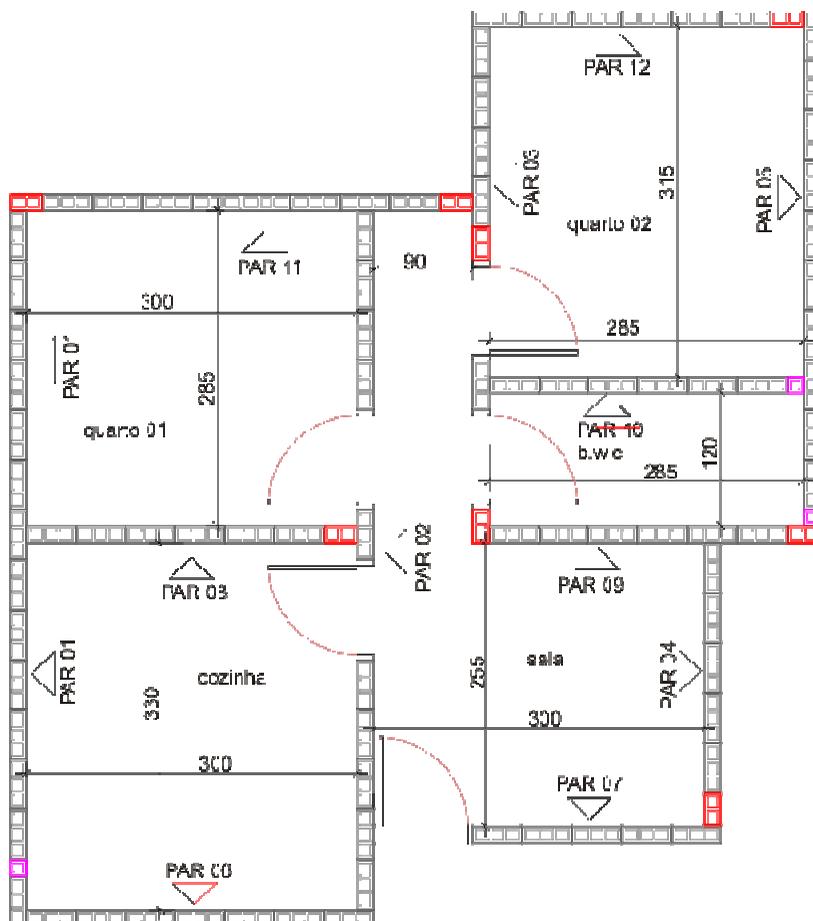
Planta de modulação primeira fiada, família do bloco 44 cm.
